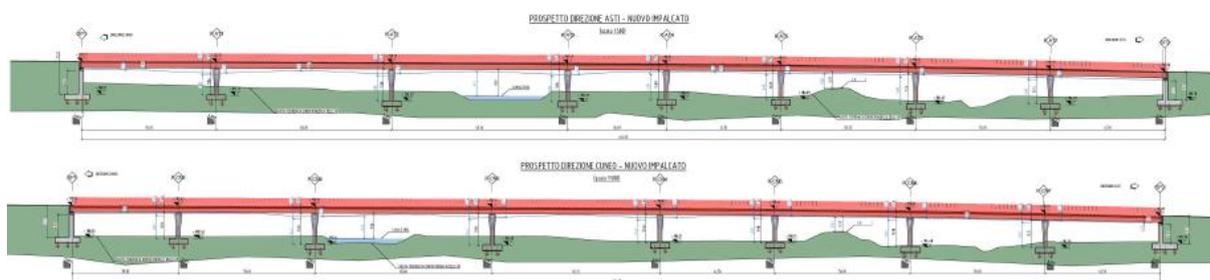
Prospetti: sopra direzione Asti, sotto direzione Cuneo
